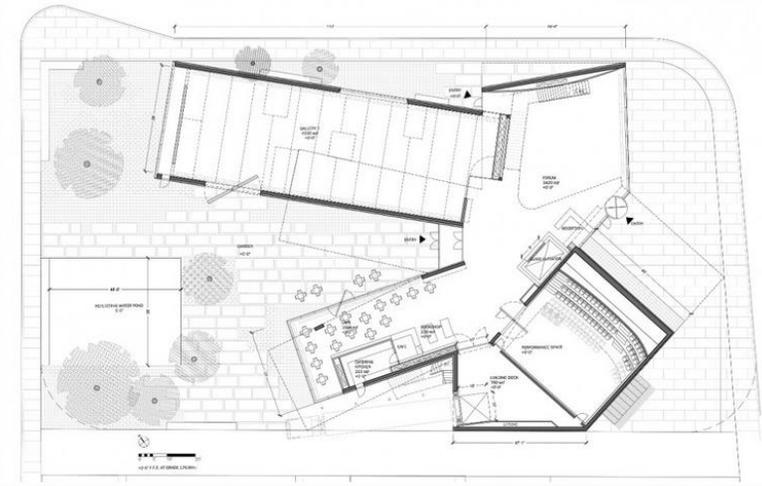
Plantas Arquitectónicas Nivel 1 y 2
